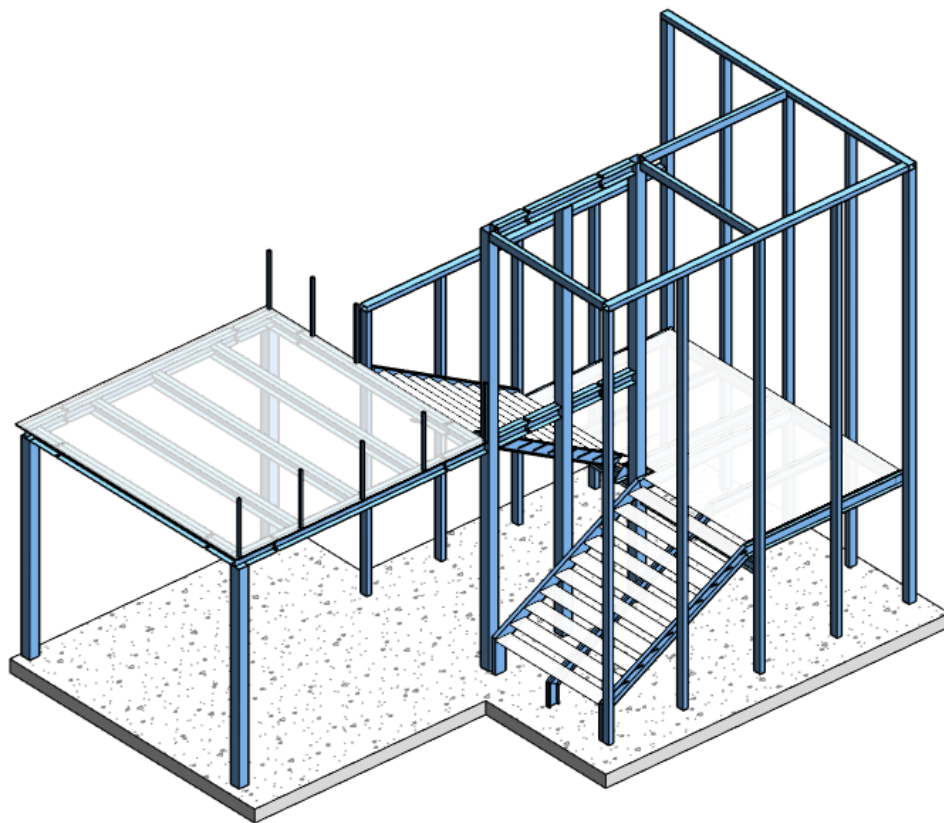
Inquadrimento Tridimensionale Strutturale della Nuova Struttura di Progetto
